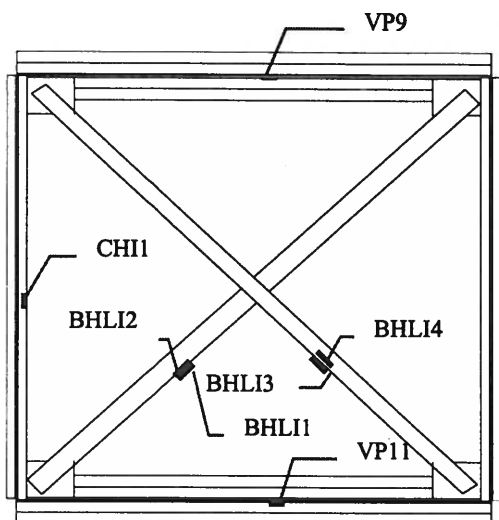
Posição dos extensómetros vista longitudinal horizontal inferior. Idêntica à realizada para a vista superior.
